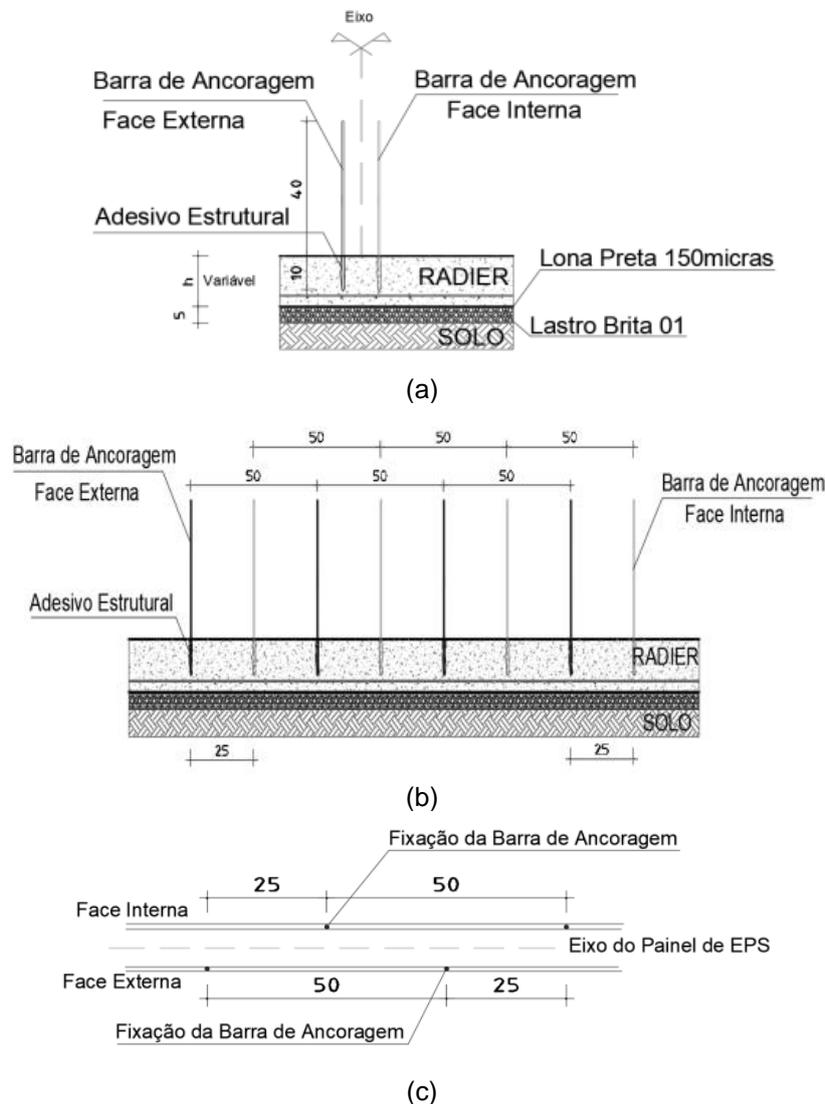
Detalhe da ligação entre painel e fundação: (a) vista lateral, (b) vista frontal, e (c) vista de planta
